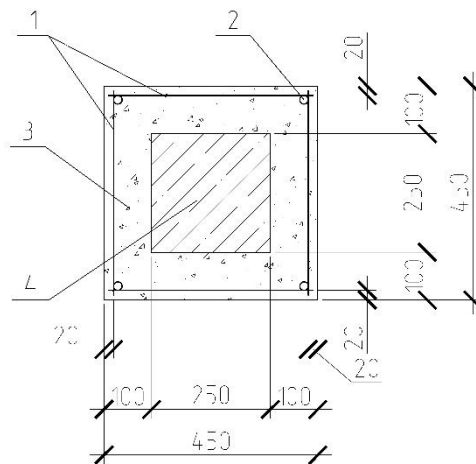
К усилению колонны железобетонной обоймой: 1 – хомуты; 2 – продольная арматура; 3 – бетон усиления; 4 – усиливаемая колонна
